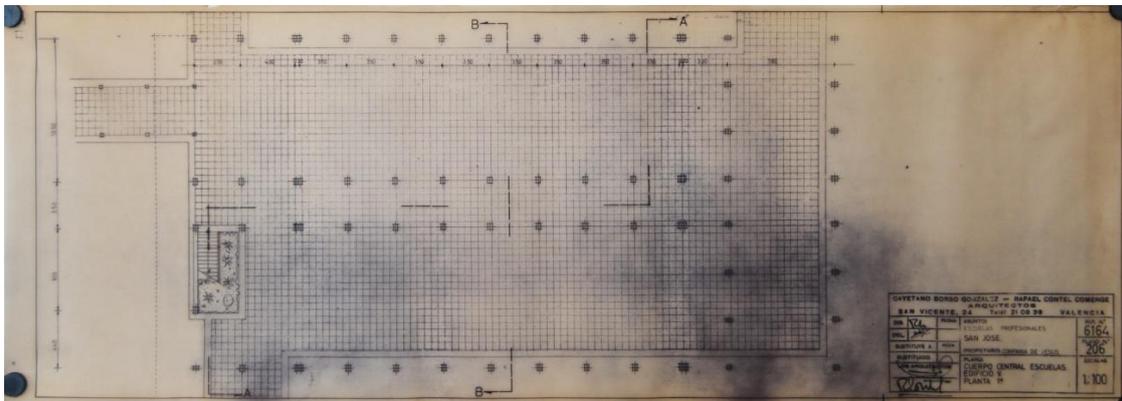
Plano de pilares pabellón aula detalle. *Archivo Escuelas San José.
